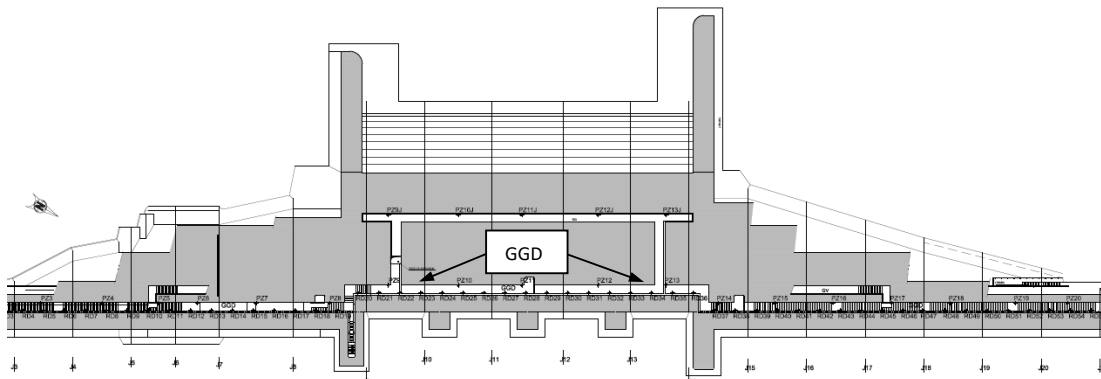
Projeto de drenos e piezómetros na galeria geral de drenagem (GGD). Planta geral. (adaptado de EDP, 2011). (PZ-piezómetro; RD-dreno; J-junta de bloco)
